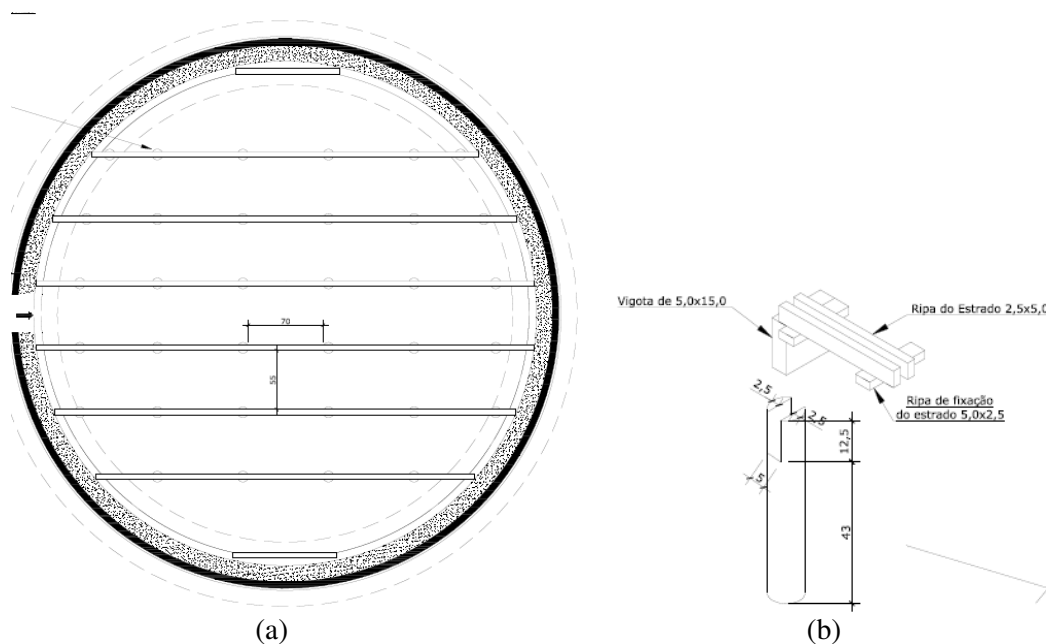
Dimensões do fundo do silo (a) e detalhamento dos apoios, vigotas e estrado (b)
